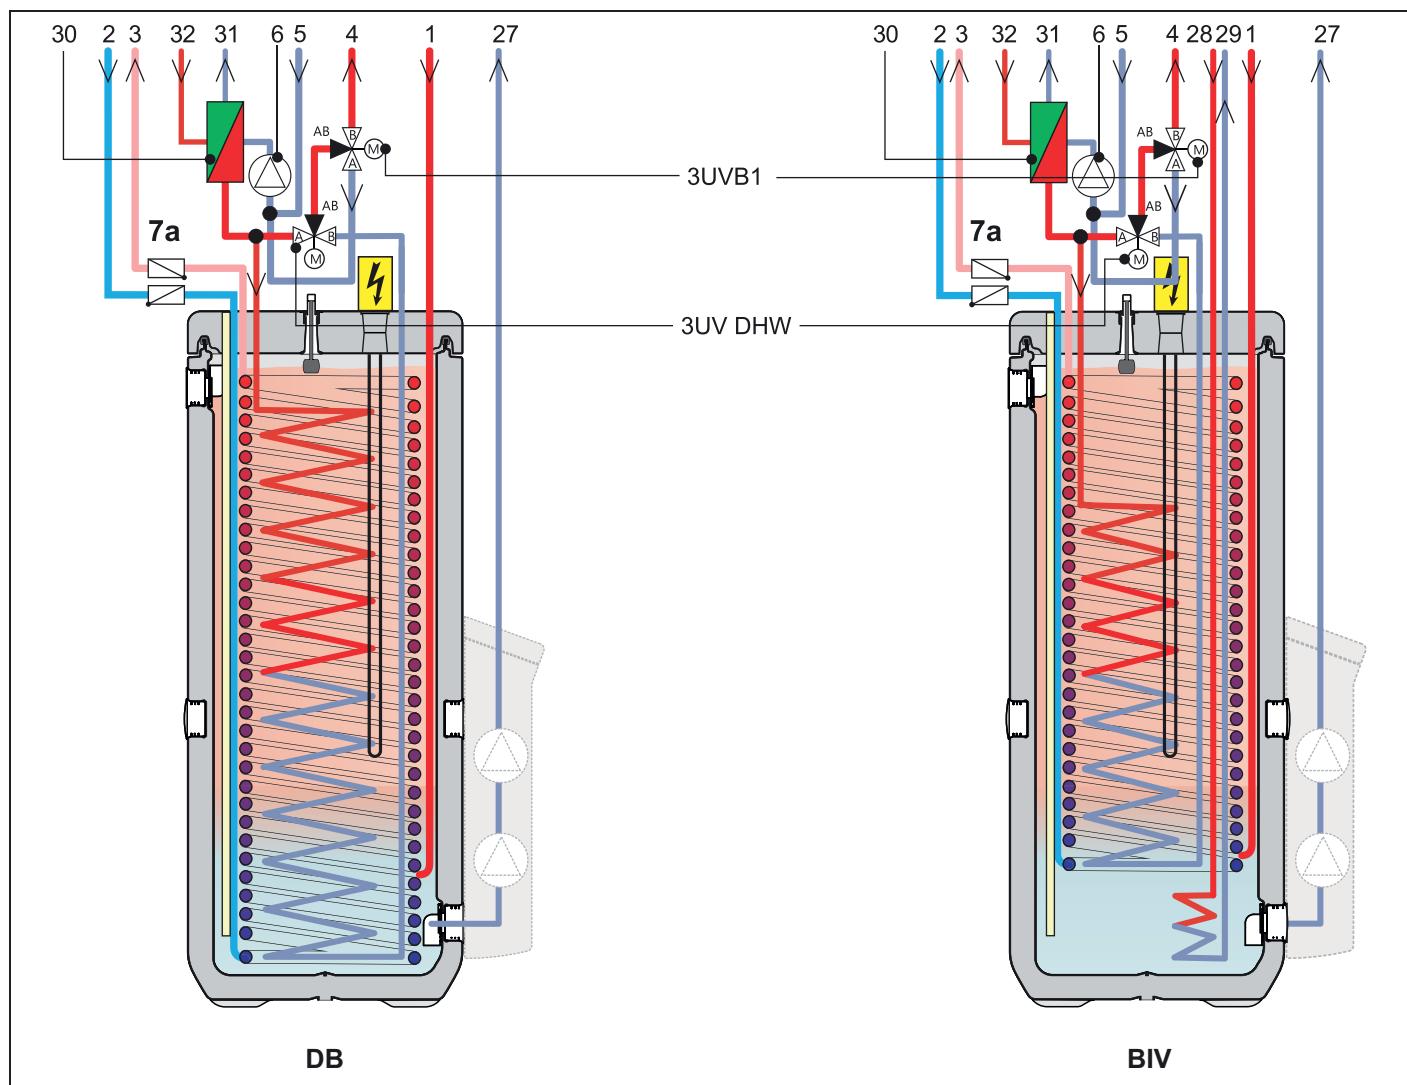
Hydraulischer Aufbau - Innengeräte - HPSU compact 3xx
